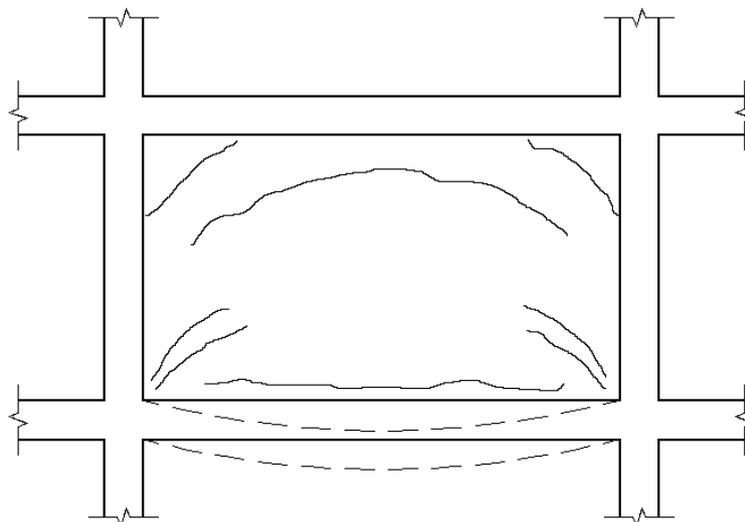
Configuração típica de fissura causada por deformação da viga inferior (THOMAZ, 1989)
